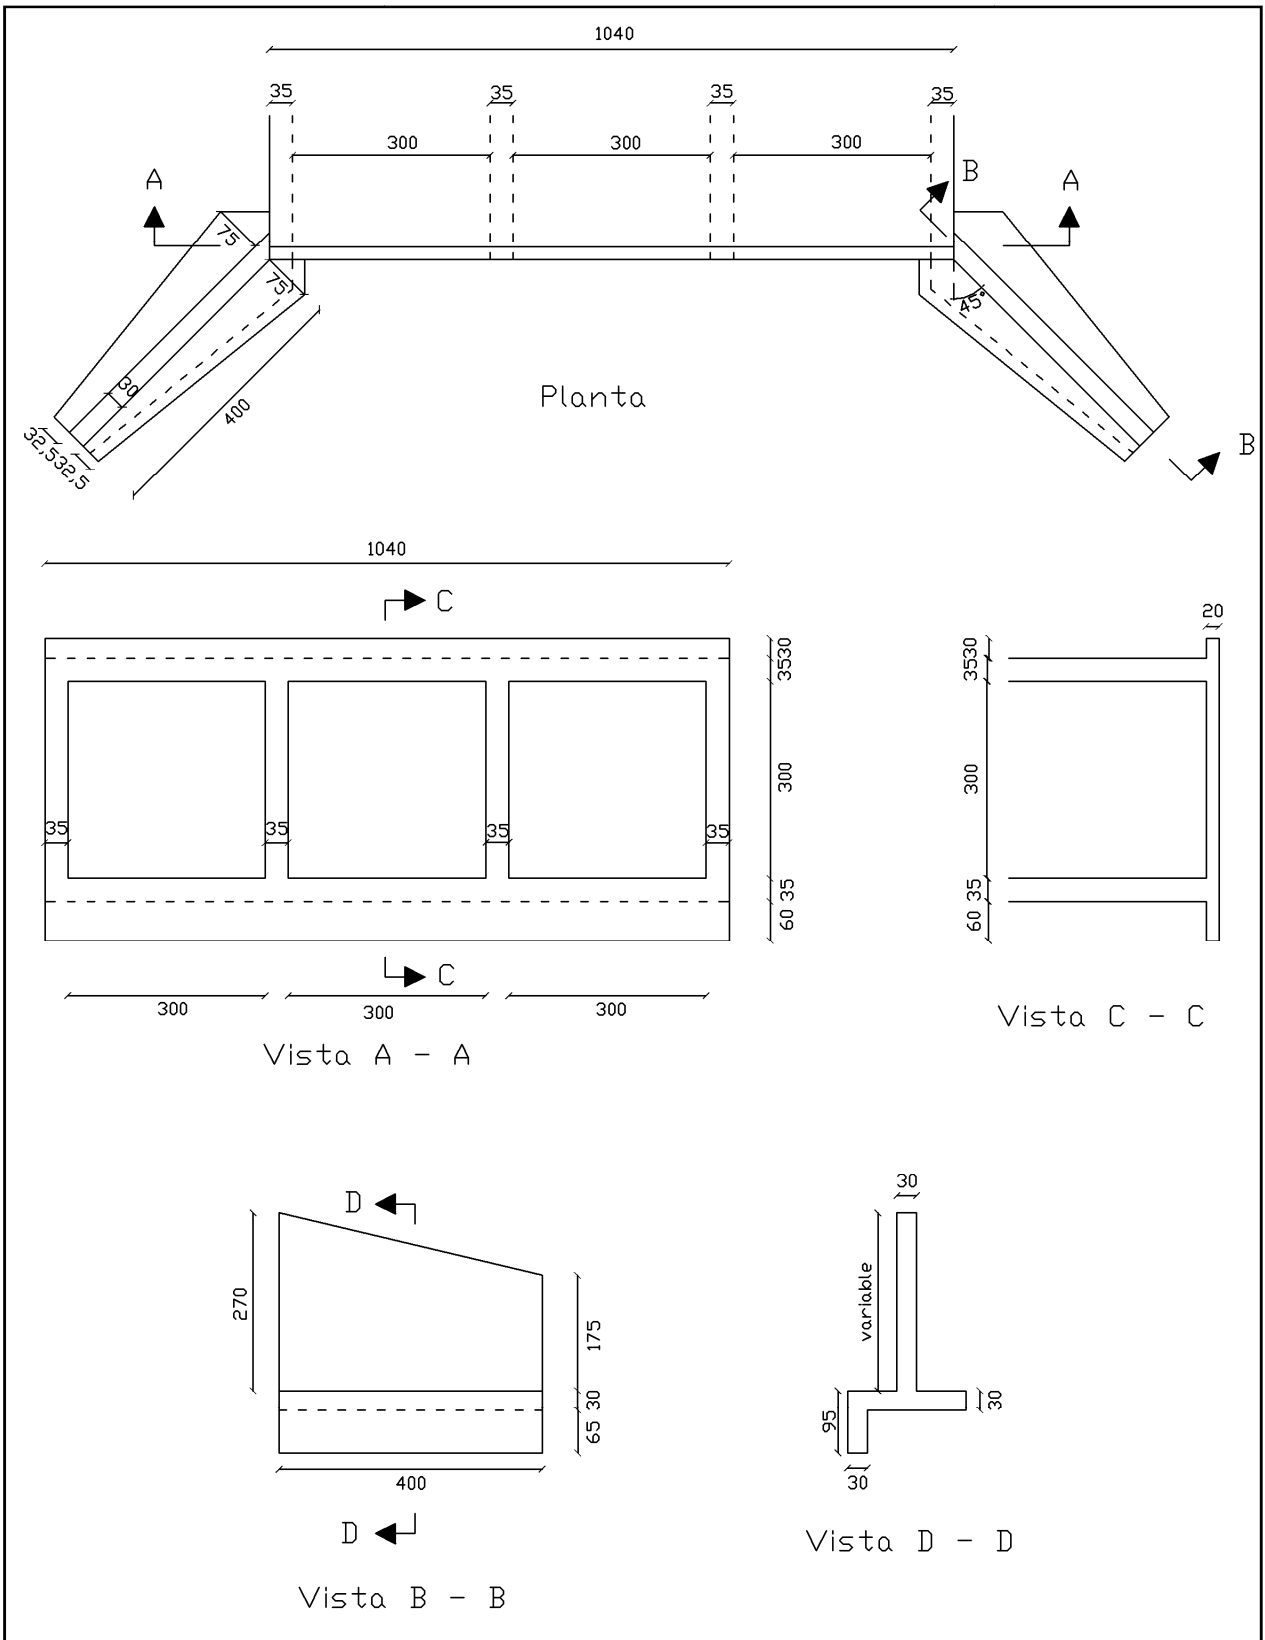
alcantarilla de cajón triple (dimensiones en cm)
